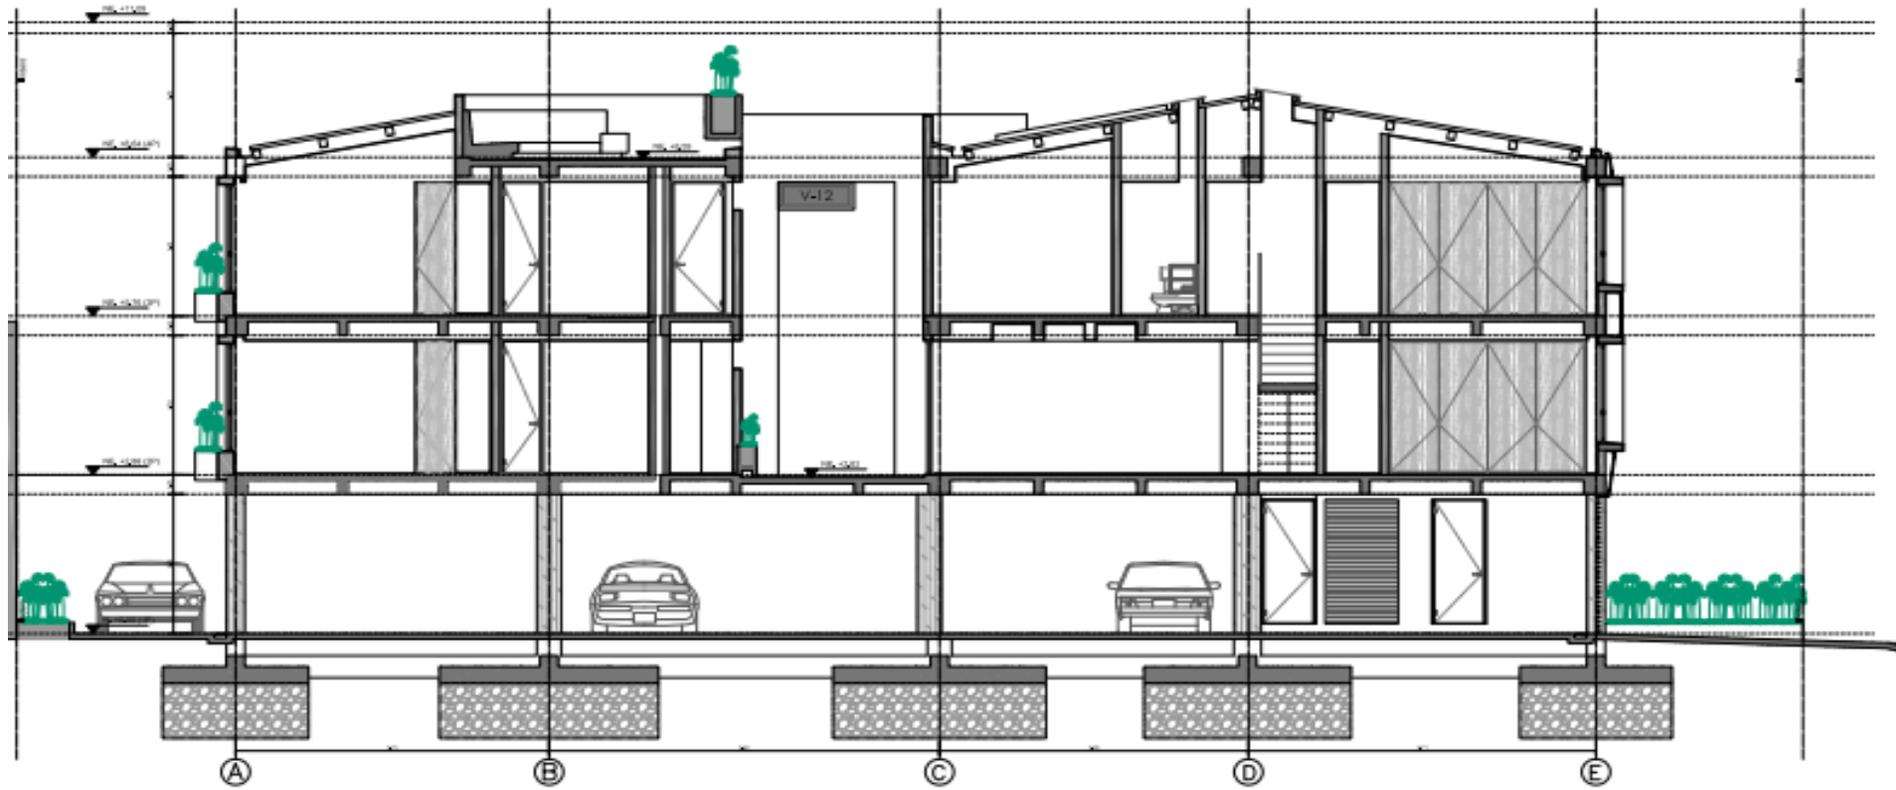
Plano arquitectónico corte trasversal. Fuente Arq. Alexander Palacio.
